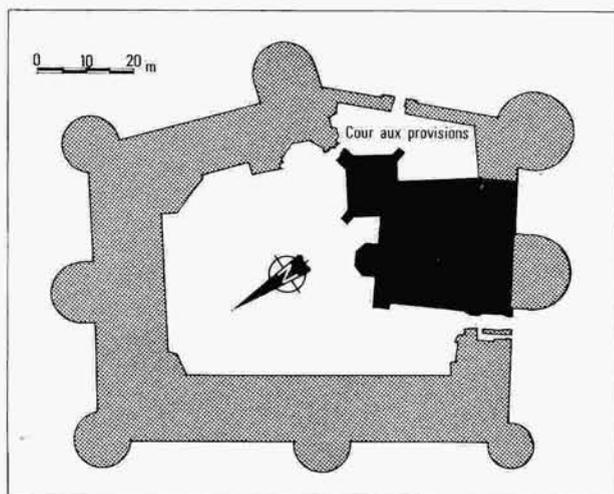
PLAN DE MASSES DE PIERREFONDS
